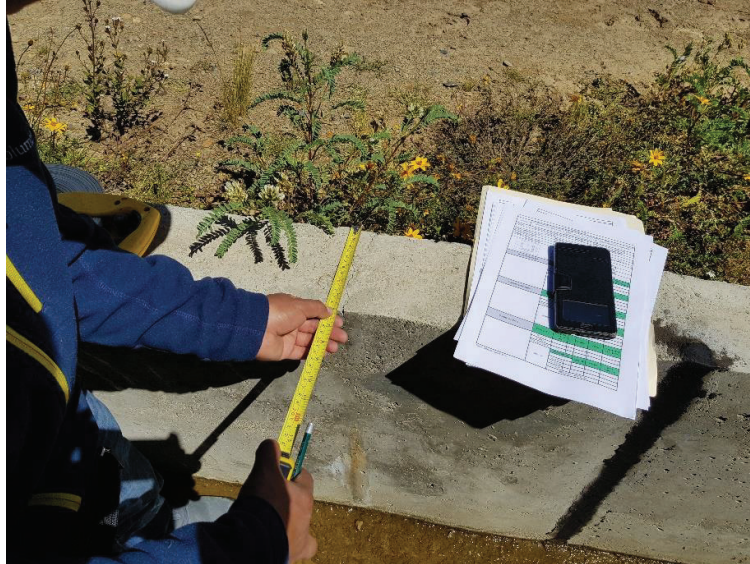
En la vista se observa haciendo las mediciones de longitud transversal de la grieta con la wincha en la unidad de muestra N° 02
